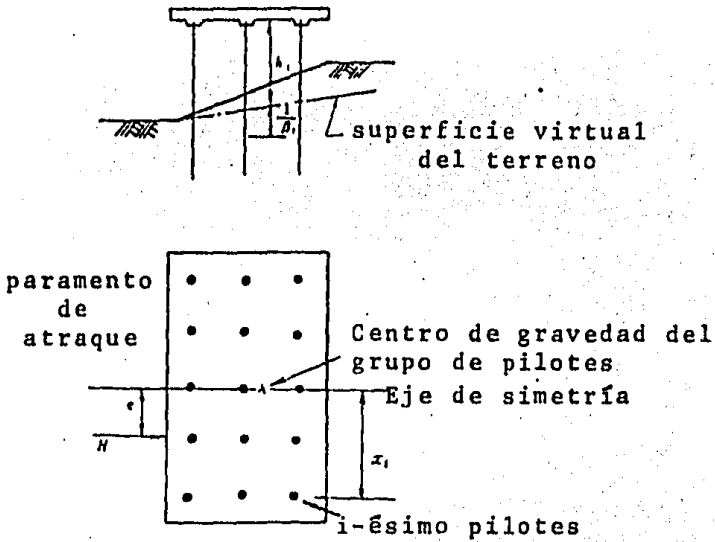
Arreglo de pilotes y punto de aplicación de la fuerza horizontal.
